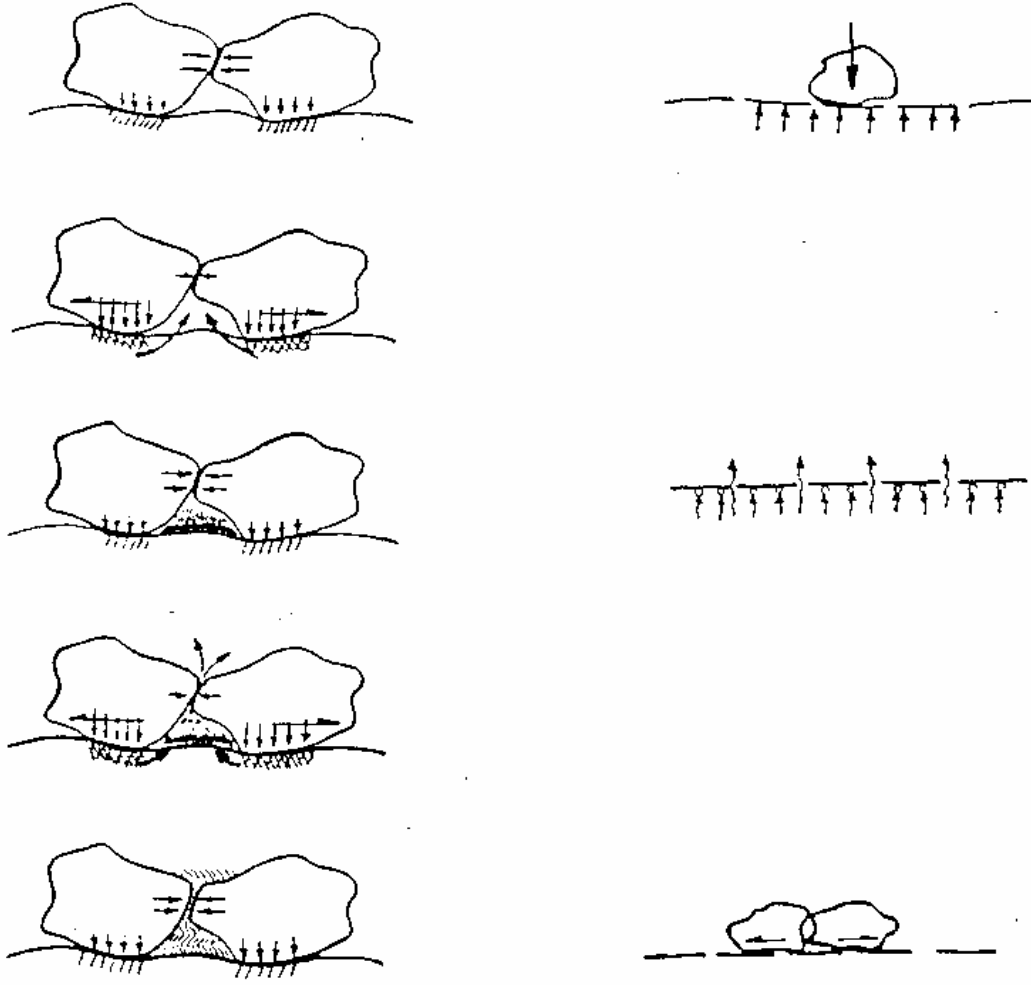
Erozyondan korunma yapılarında geotekstil kullanımı [6]
